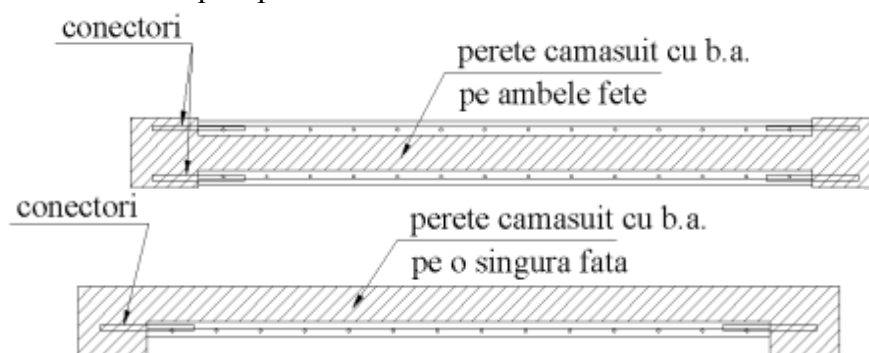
Consolidarea diafragmelor din beton armat prin cămășuire
